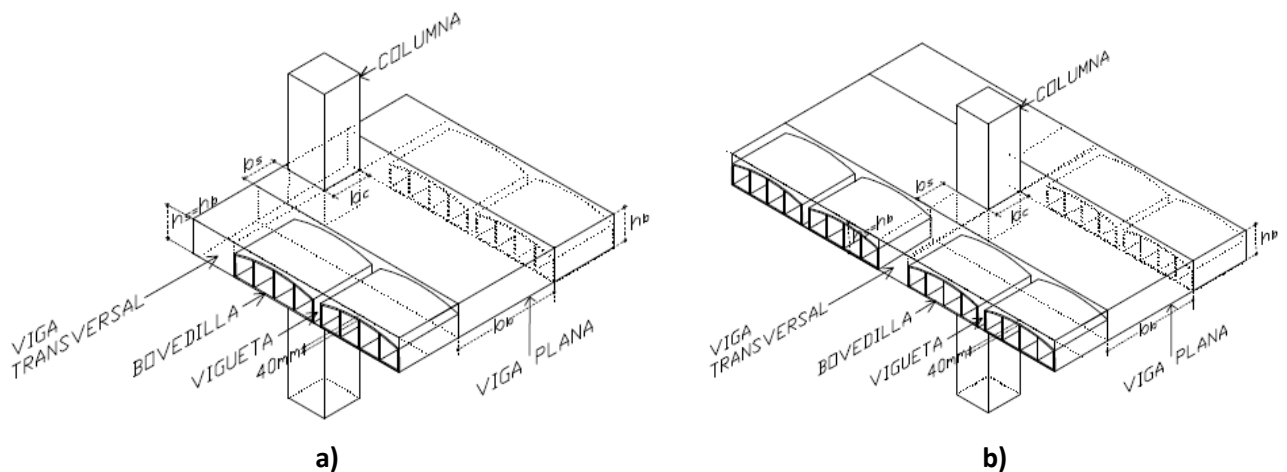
Detalle de conexiones viga plana-pilar.
